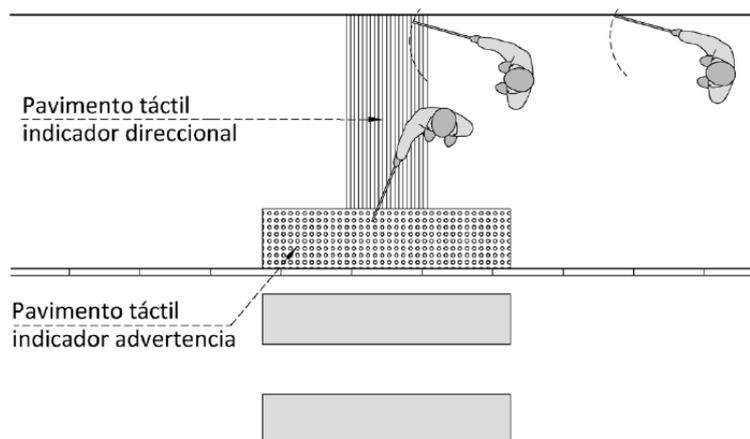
Esquema en planta de pavimento podotáctil para punto de cruce.
